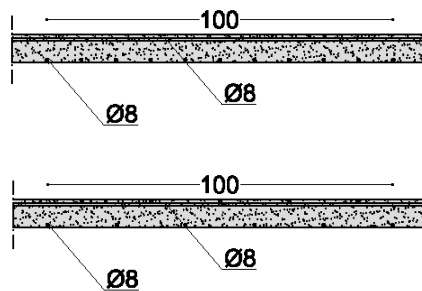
particolare del solaio a nervature parallele - sezione longitudinale della soletta (da Archivio Storico del Comune di Salerno).
